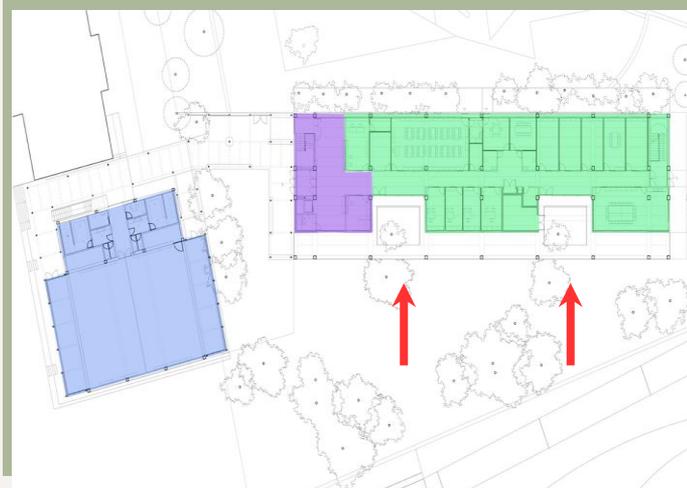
PLANTA TÉRREO DO INSTITUTO BADIA I MARGARIT
